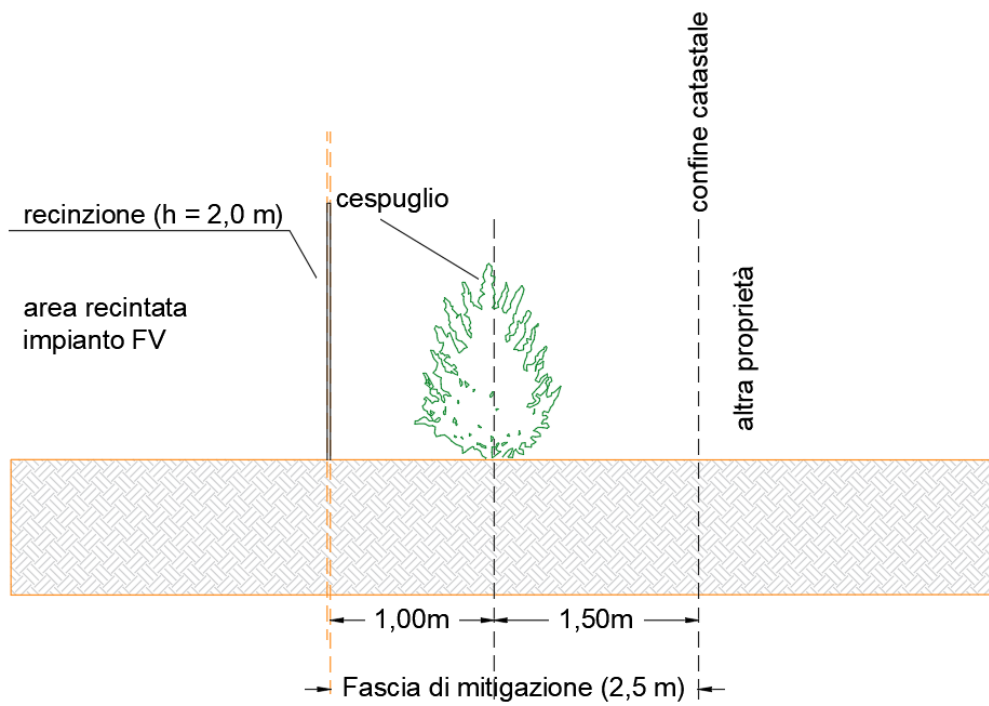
Stralcio di sezione della siepe dell'area perimetrale dell'impianto.
